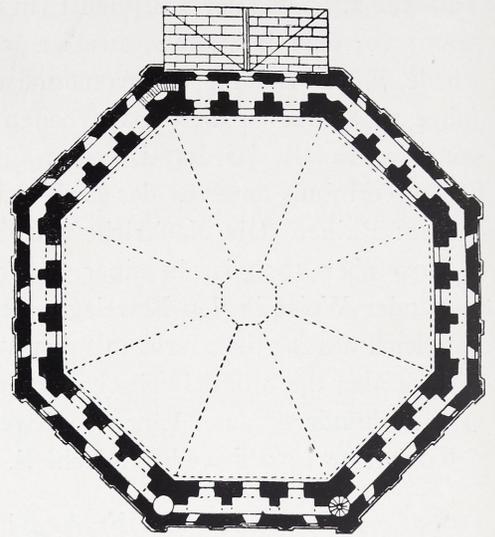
Florenz, Baptisterium, Grundriß des Erdgeschosses (nach Swoboda, Baptisterium)
